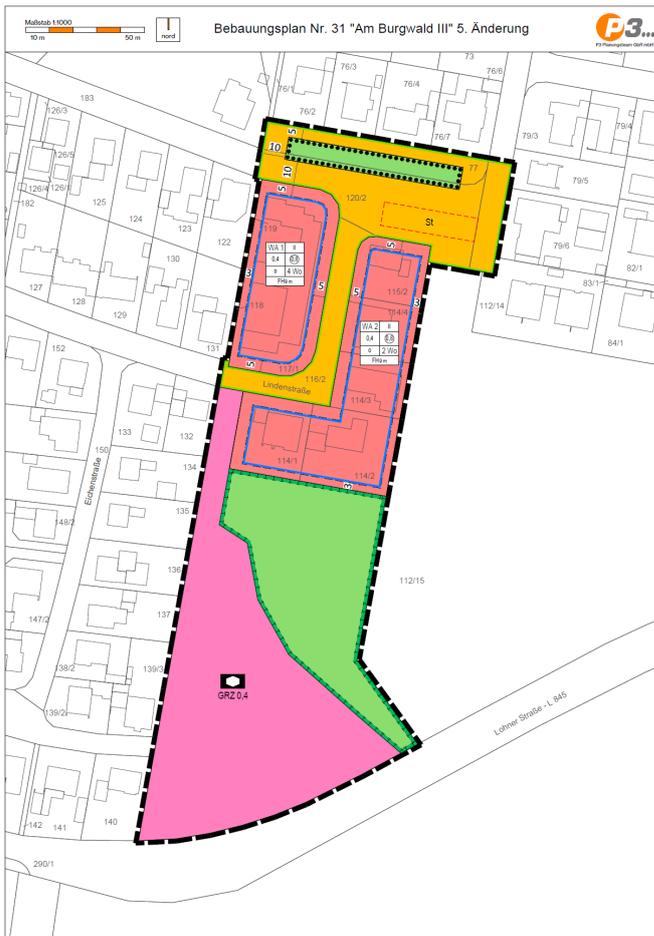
Ausschnitt aus dem Vorentwurf des Bebauungsplans Nr. 31 [6], Stand 06.07.2023
